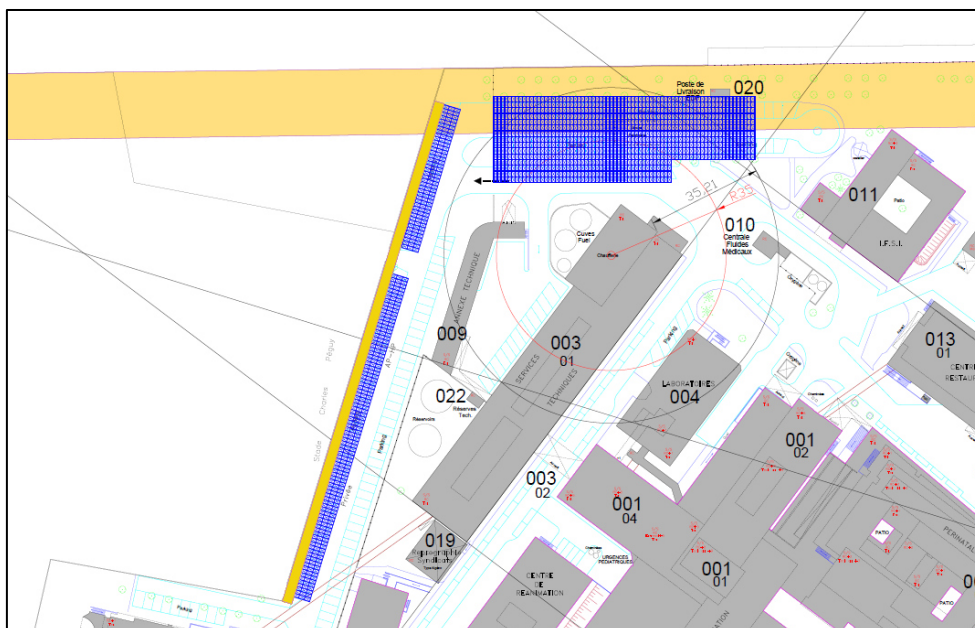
Extrait du plan d'implantation des panneaux solaires
